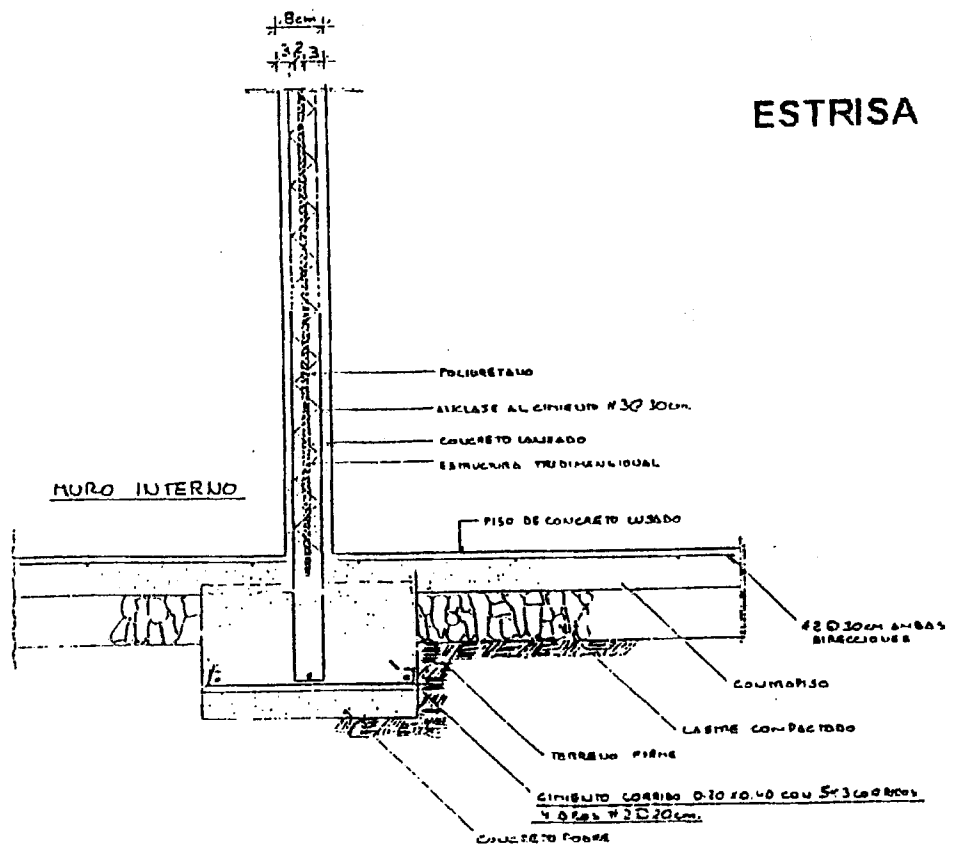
UNION MURO-CIMIENTO (ESTRISA)
